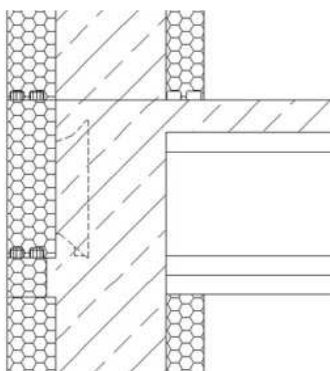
Parede e laje com elemento de compensação no fecho de laje (ARGISOL, 2010).
